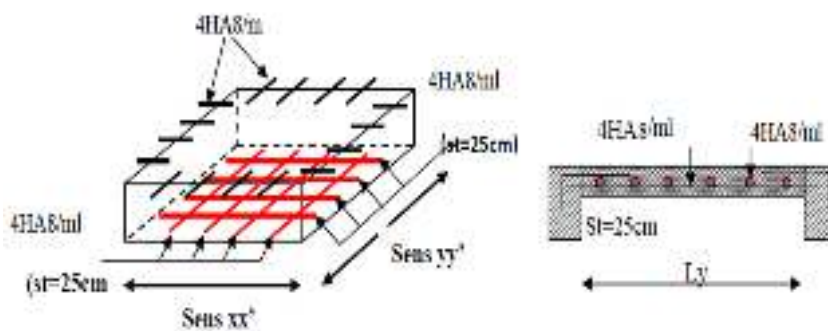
Coupe A-A detail de ferrailage et le Schéma de ferrailage de la dalle de l'ascenseur
